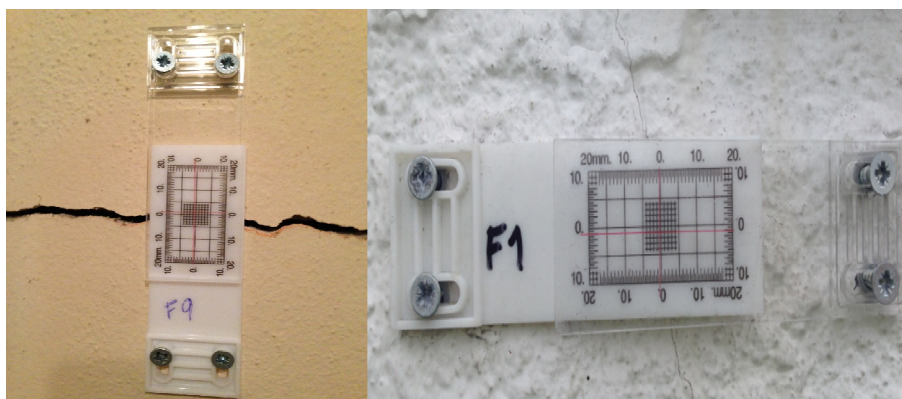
Fissurômetros *Tell-Tale* (arquivo fotos RRC; com autorização).
